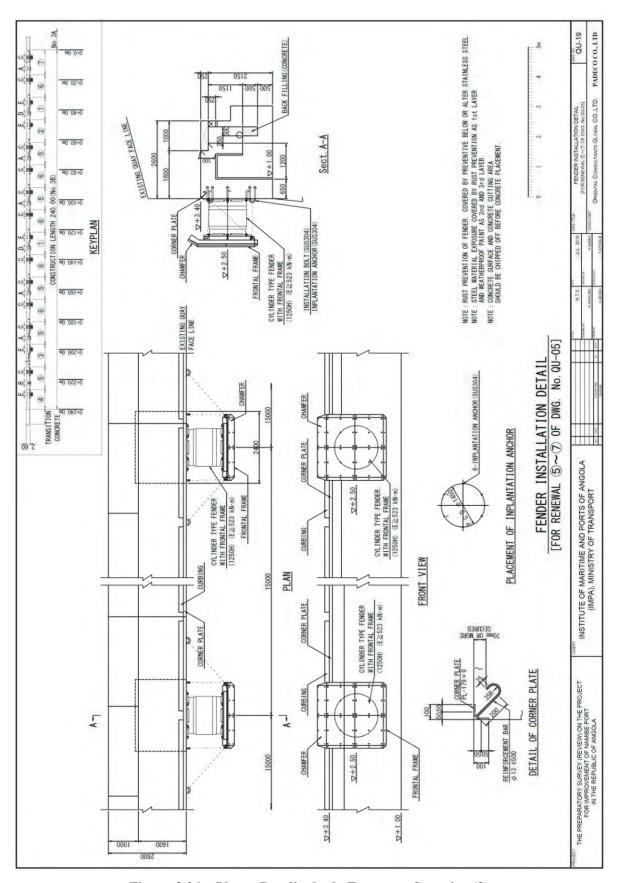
Planta Detalhada da Estrutura Superior (3)
